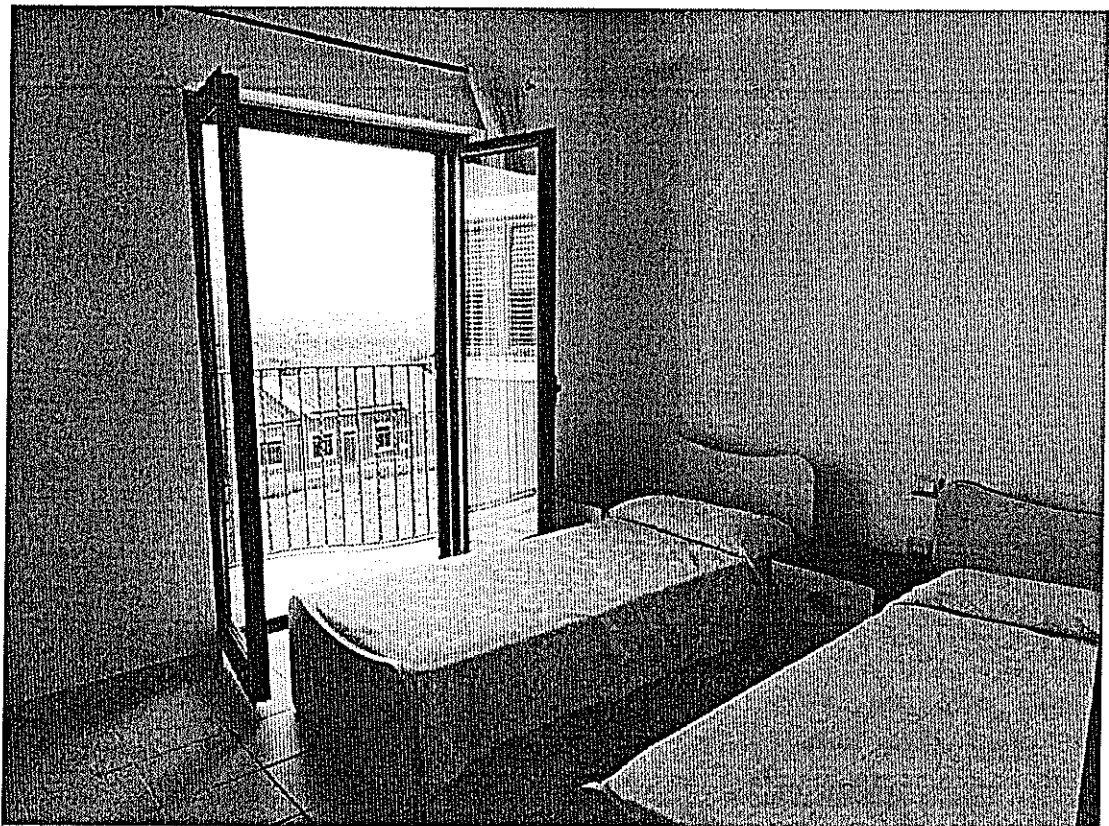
Camera tipo a 2 posti letto del primo corpo di fabbrica – piano primo.
